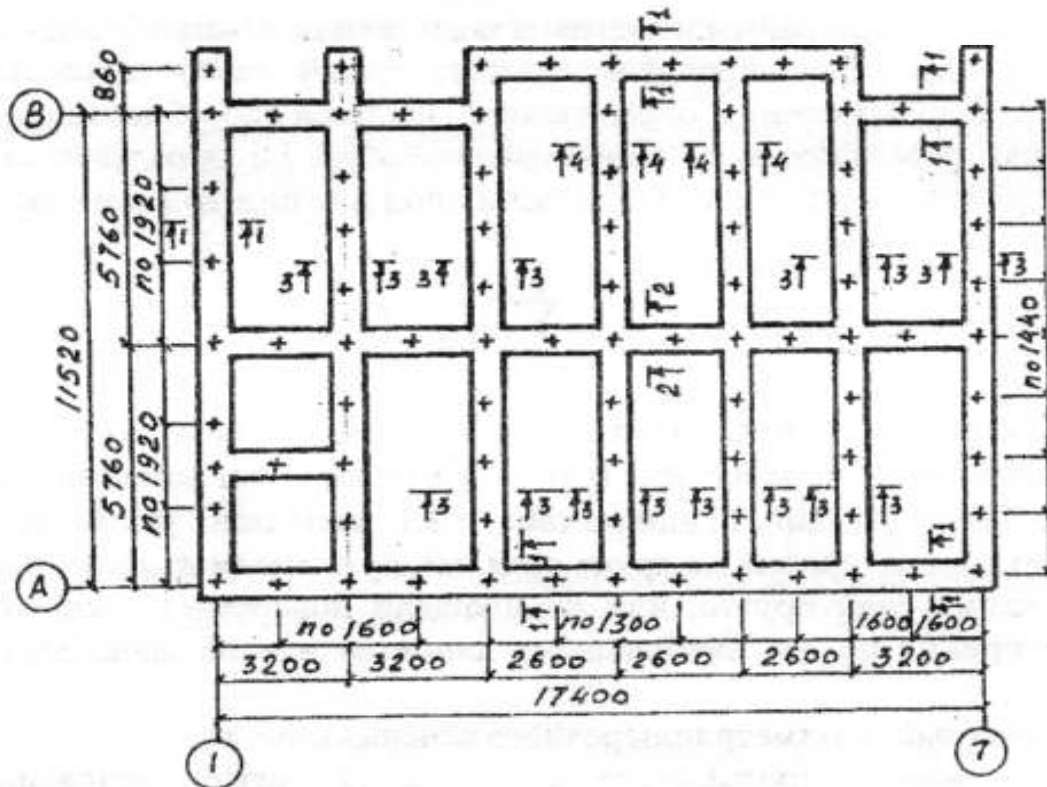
План типовой секции крупнопанельного жилого дома с указанием расчетных сечений и плана расстановки свай
